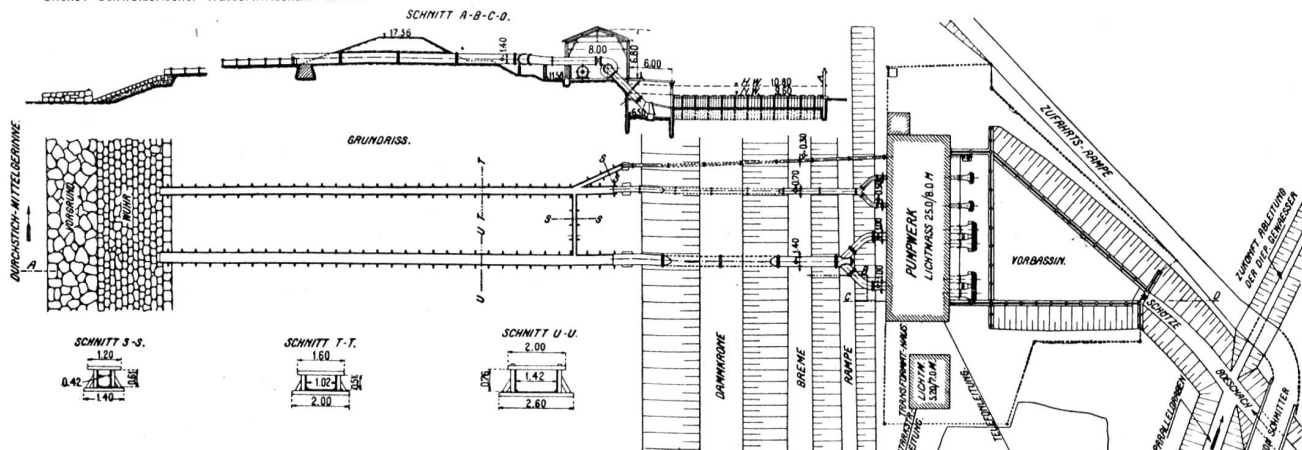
Pumpwerk Diepoldsau. Grundriss und Schnitte. Maßstab 1 : 1000 und 1 : 250.
